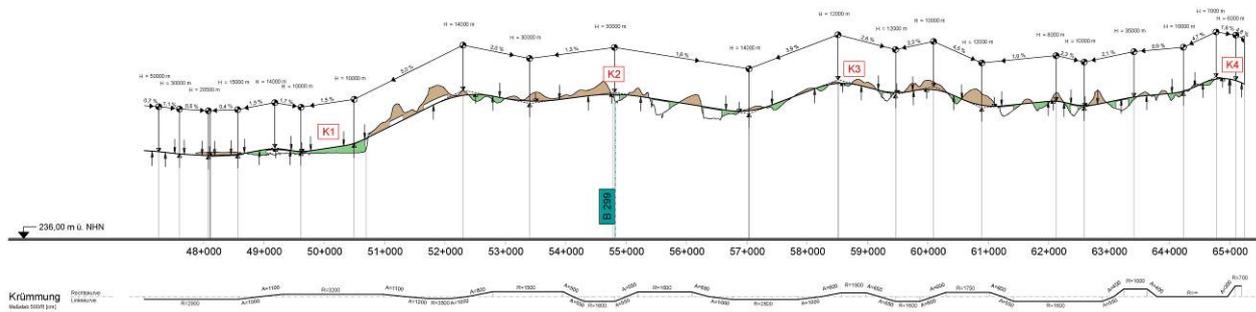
Höhenplan Planfall 1a (Unterlage 4, Blatt 1)
